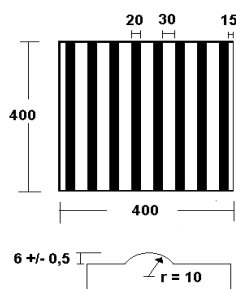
Planta do piso de cautela numa peça de 400 mm por 400 mm
